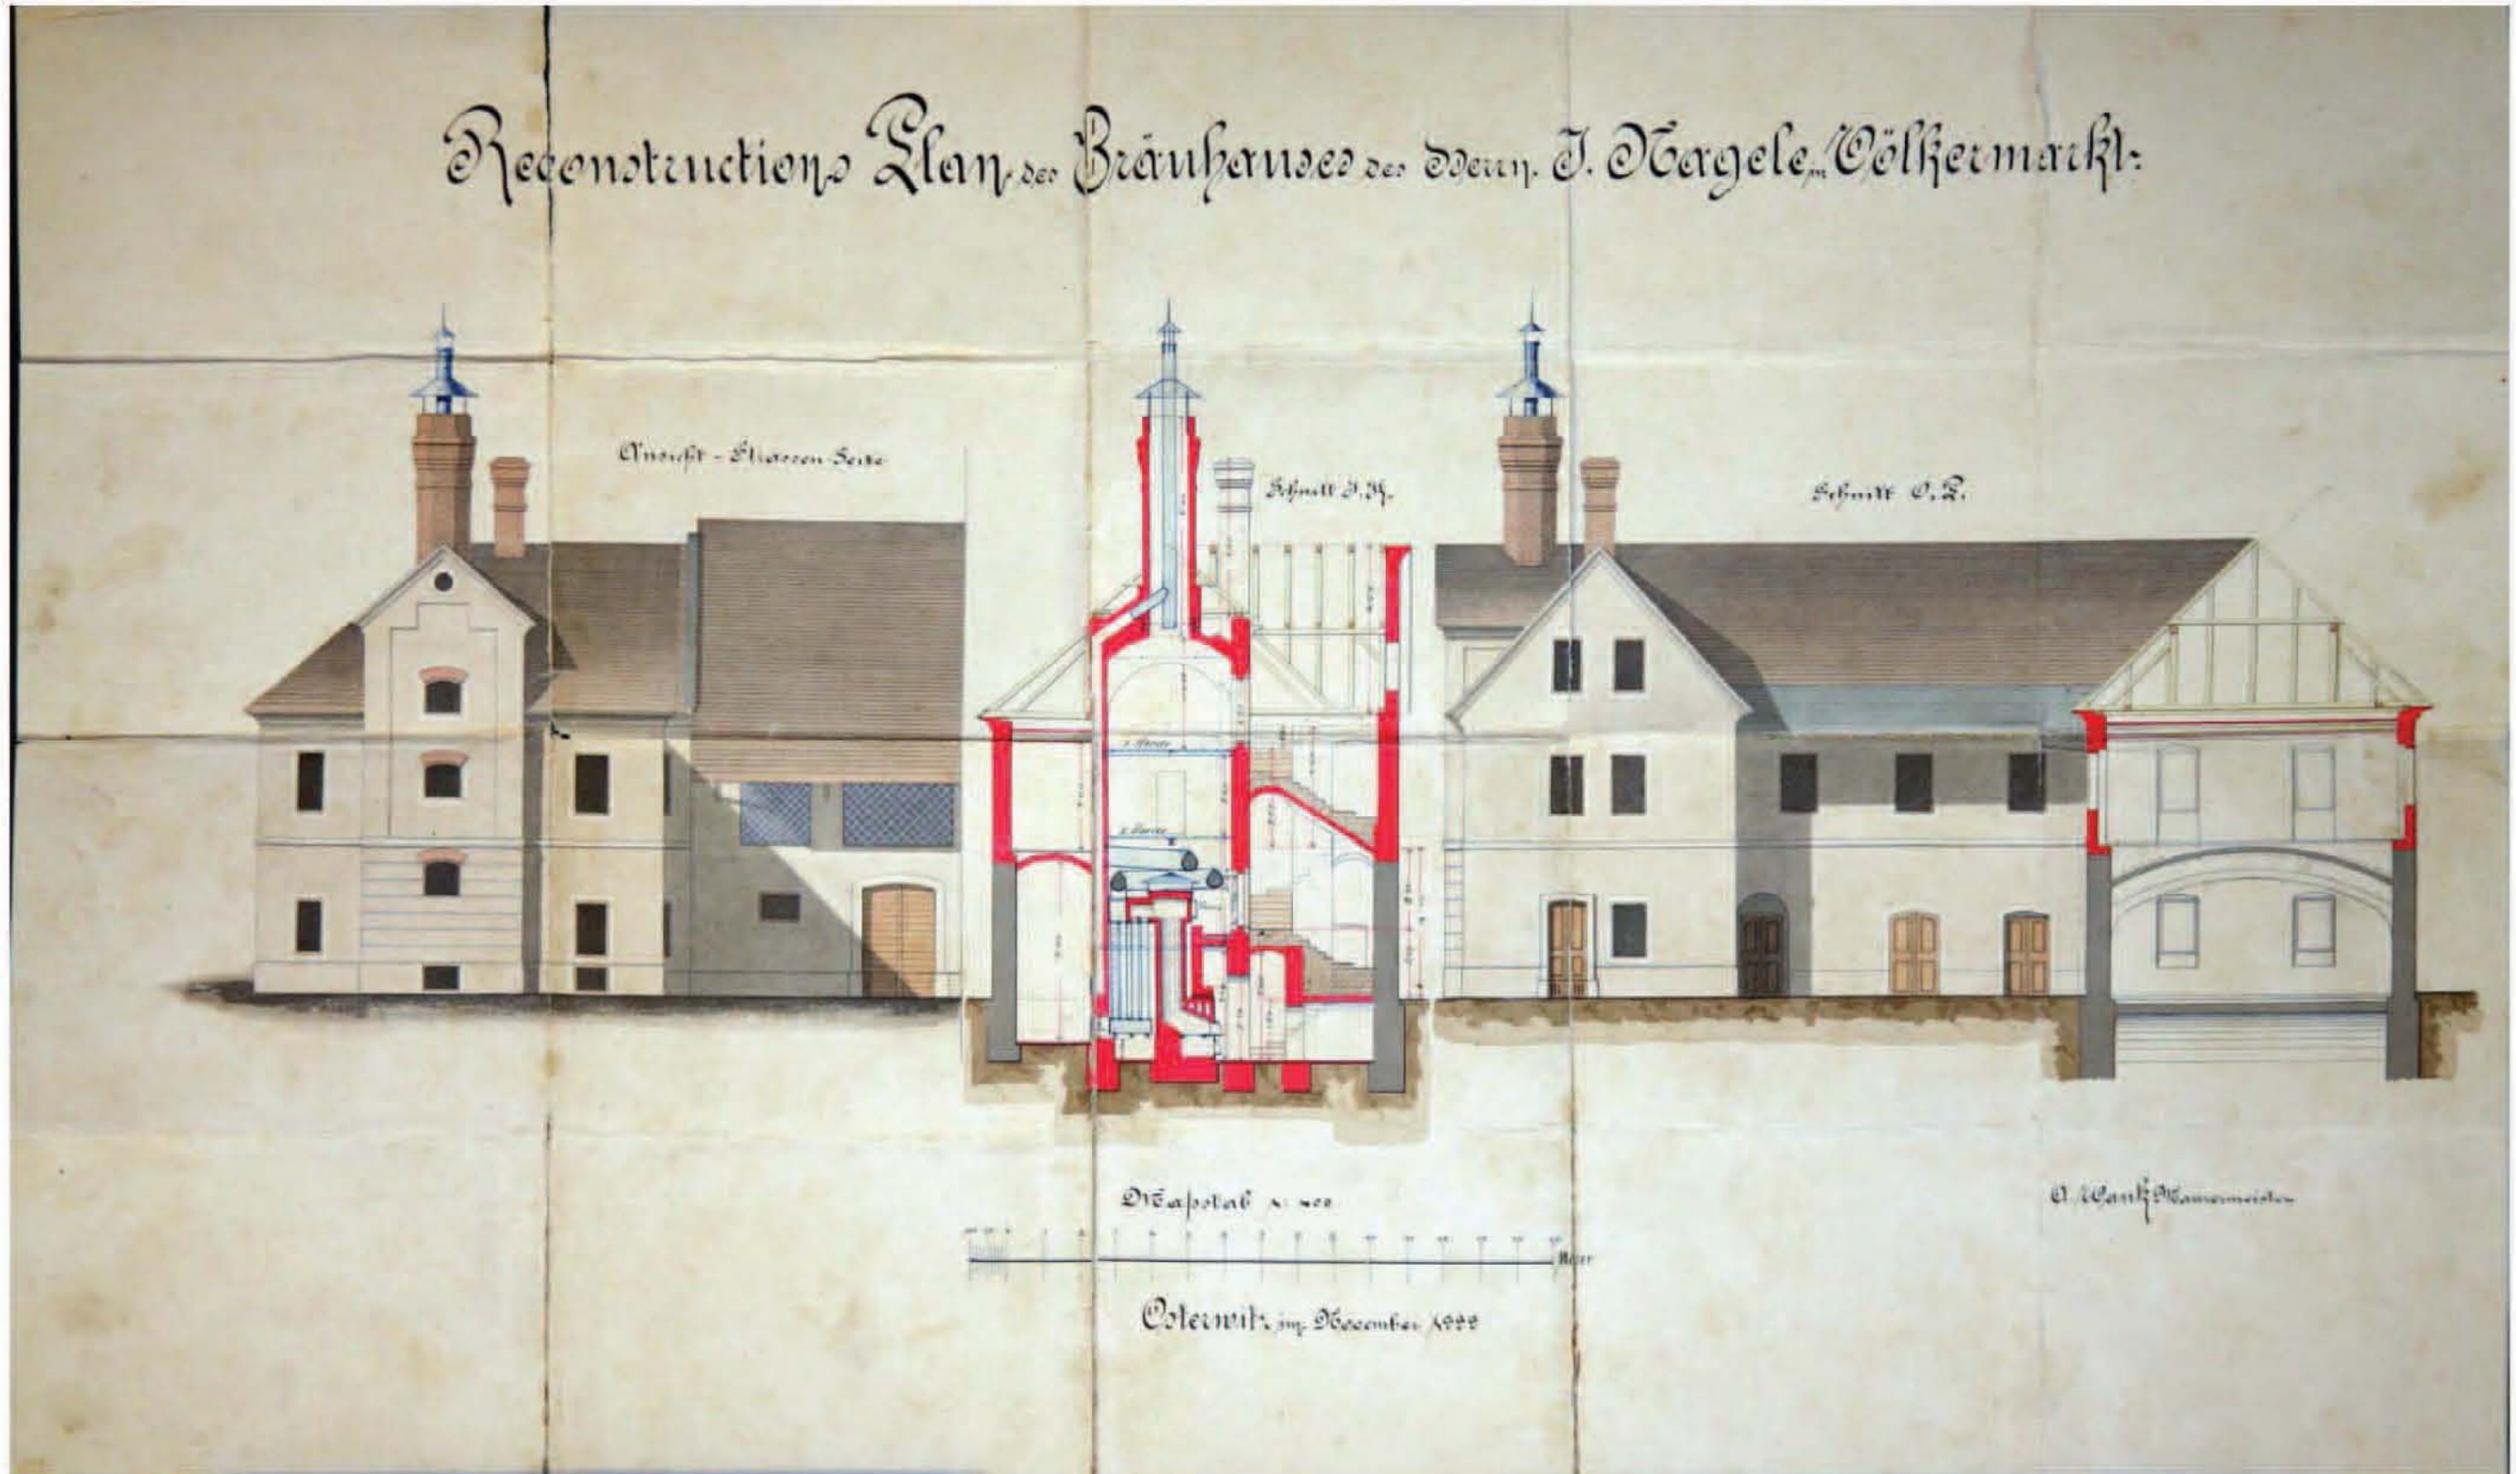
Ost- und Westansichten und Schnitt des Brauereigebäudes 1888
